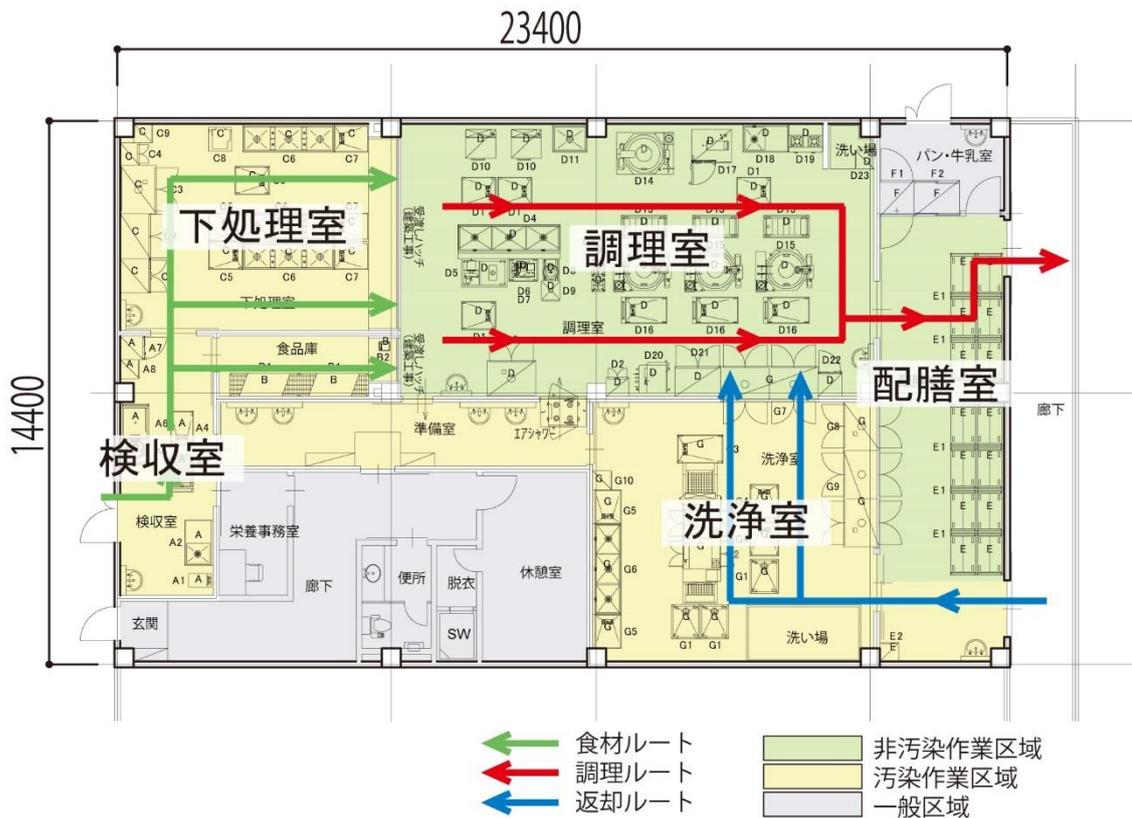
給食室想定平面図 (モデル3 600食 414.72 m²)
